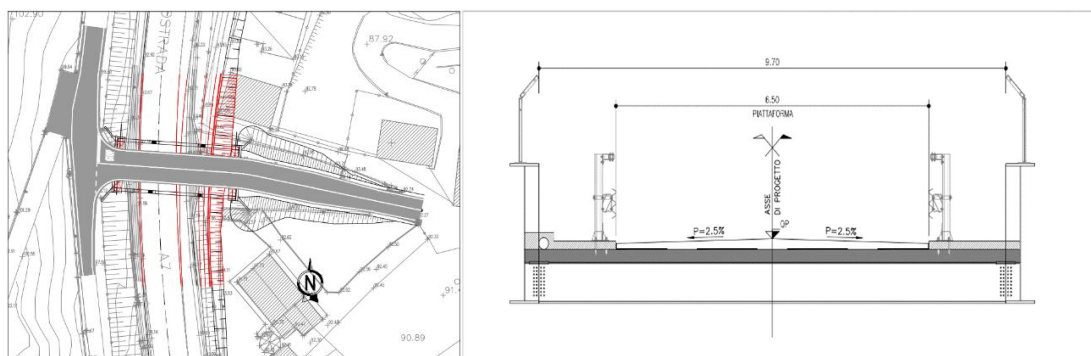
IN006 e Sezione tipo CV001 – Soluzione di progetto
